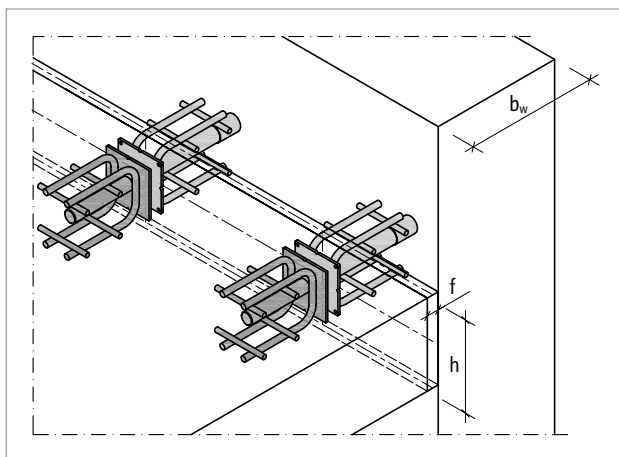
Bemessungsbeispiel Anschluss Decke an Wand
